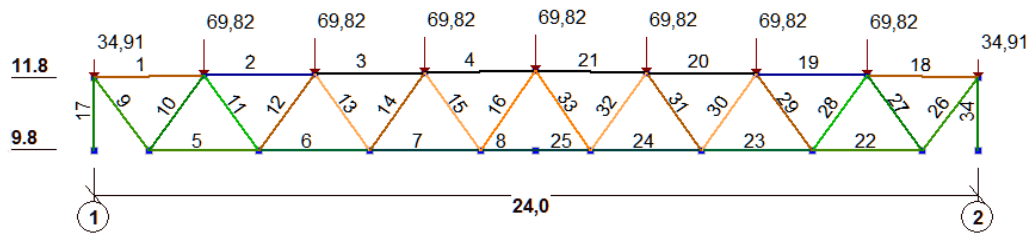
Расчетная схема фермы с приложением суммарной нагрузки (постоянная+снег) в программном комплексе «СКАД» с номерами элементов фермы
